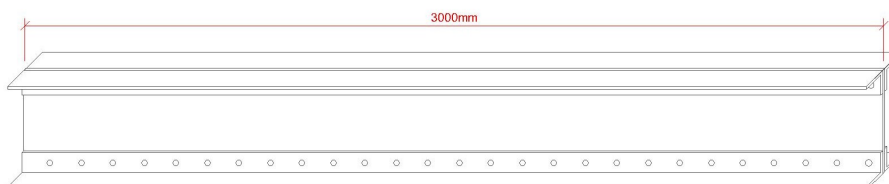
Dimensions des poutrelles extraites du pont
